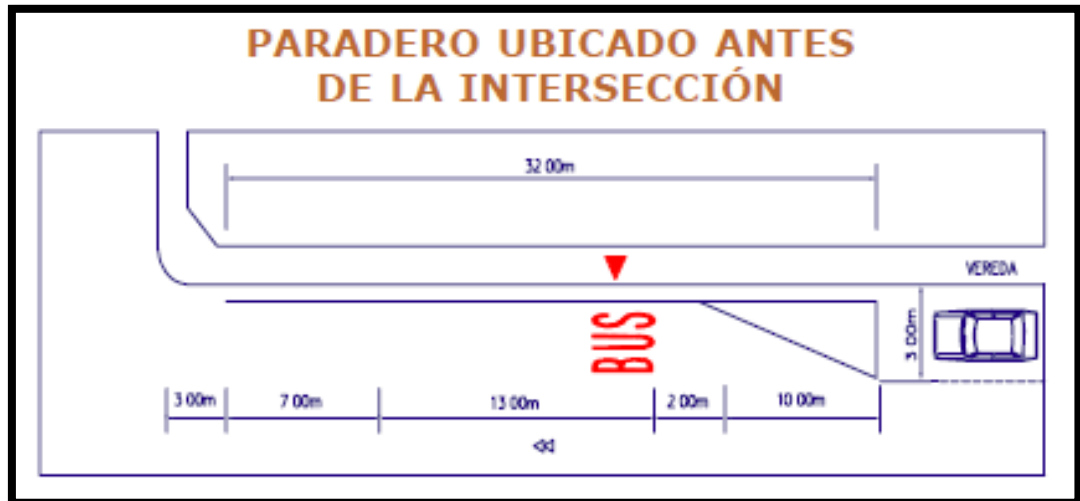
, Paradero Ubicado Antes de la Intersección.
